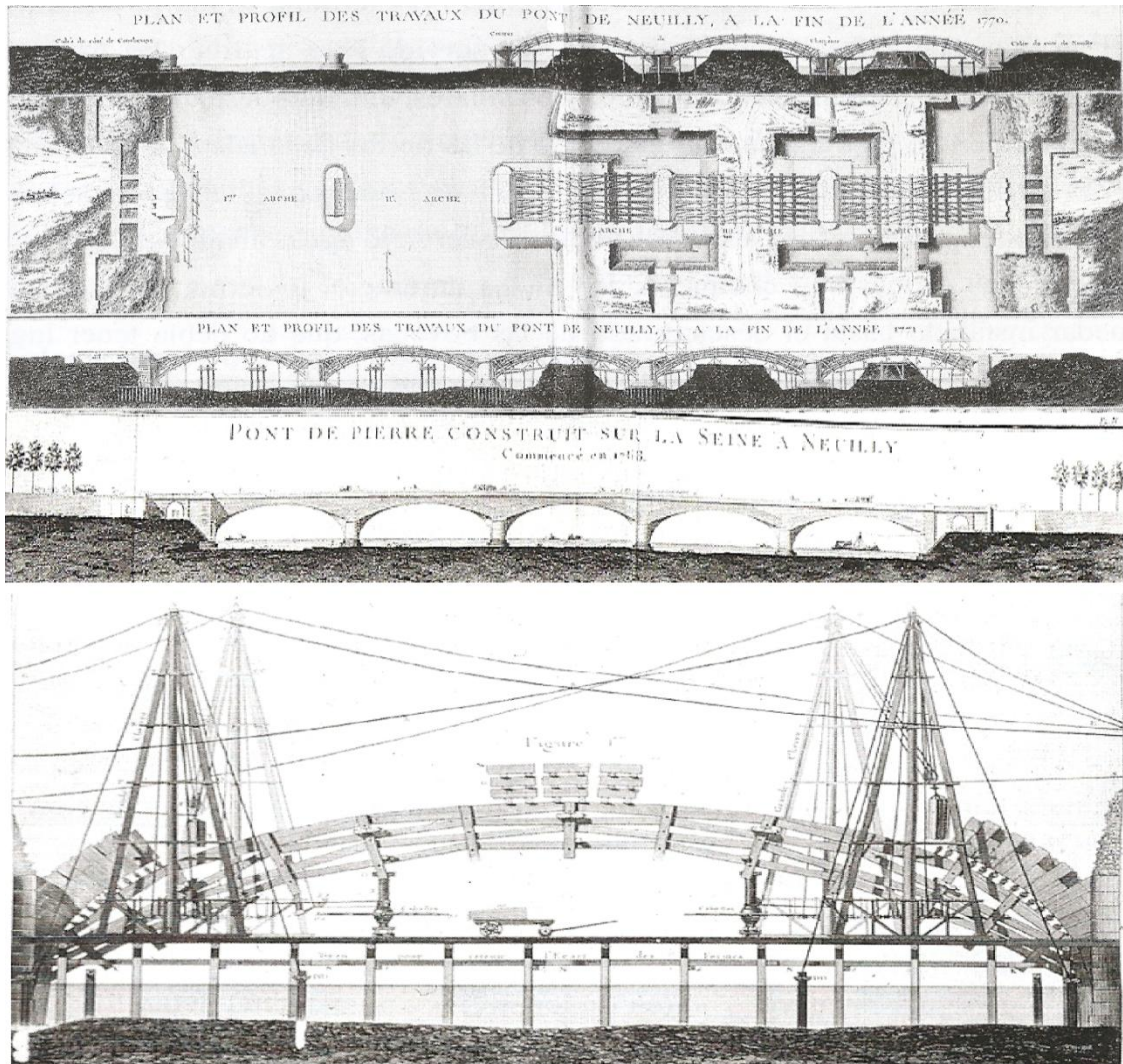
Proceso constructivo del Puente de Neuilly de Perronet, así también el detalle de las máquinas utilizadas y la colocación de las piedras. El descimbrado simultáneo se hizo 1772 en presencia del rey de Francia.
